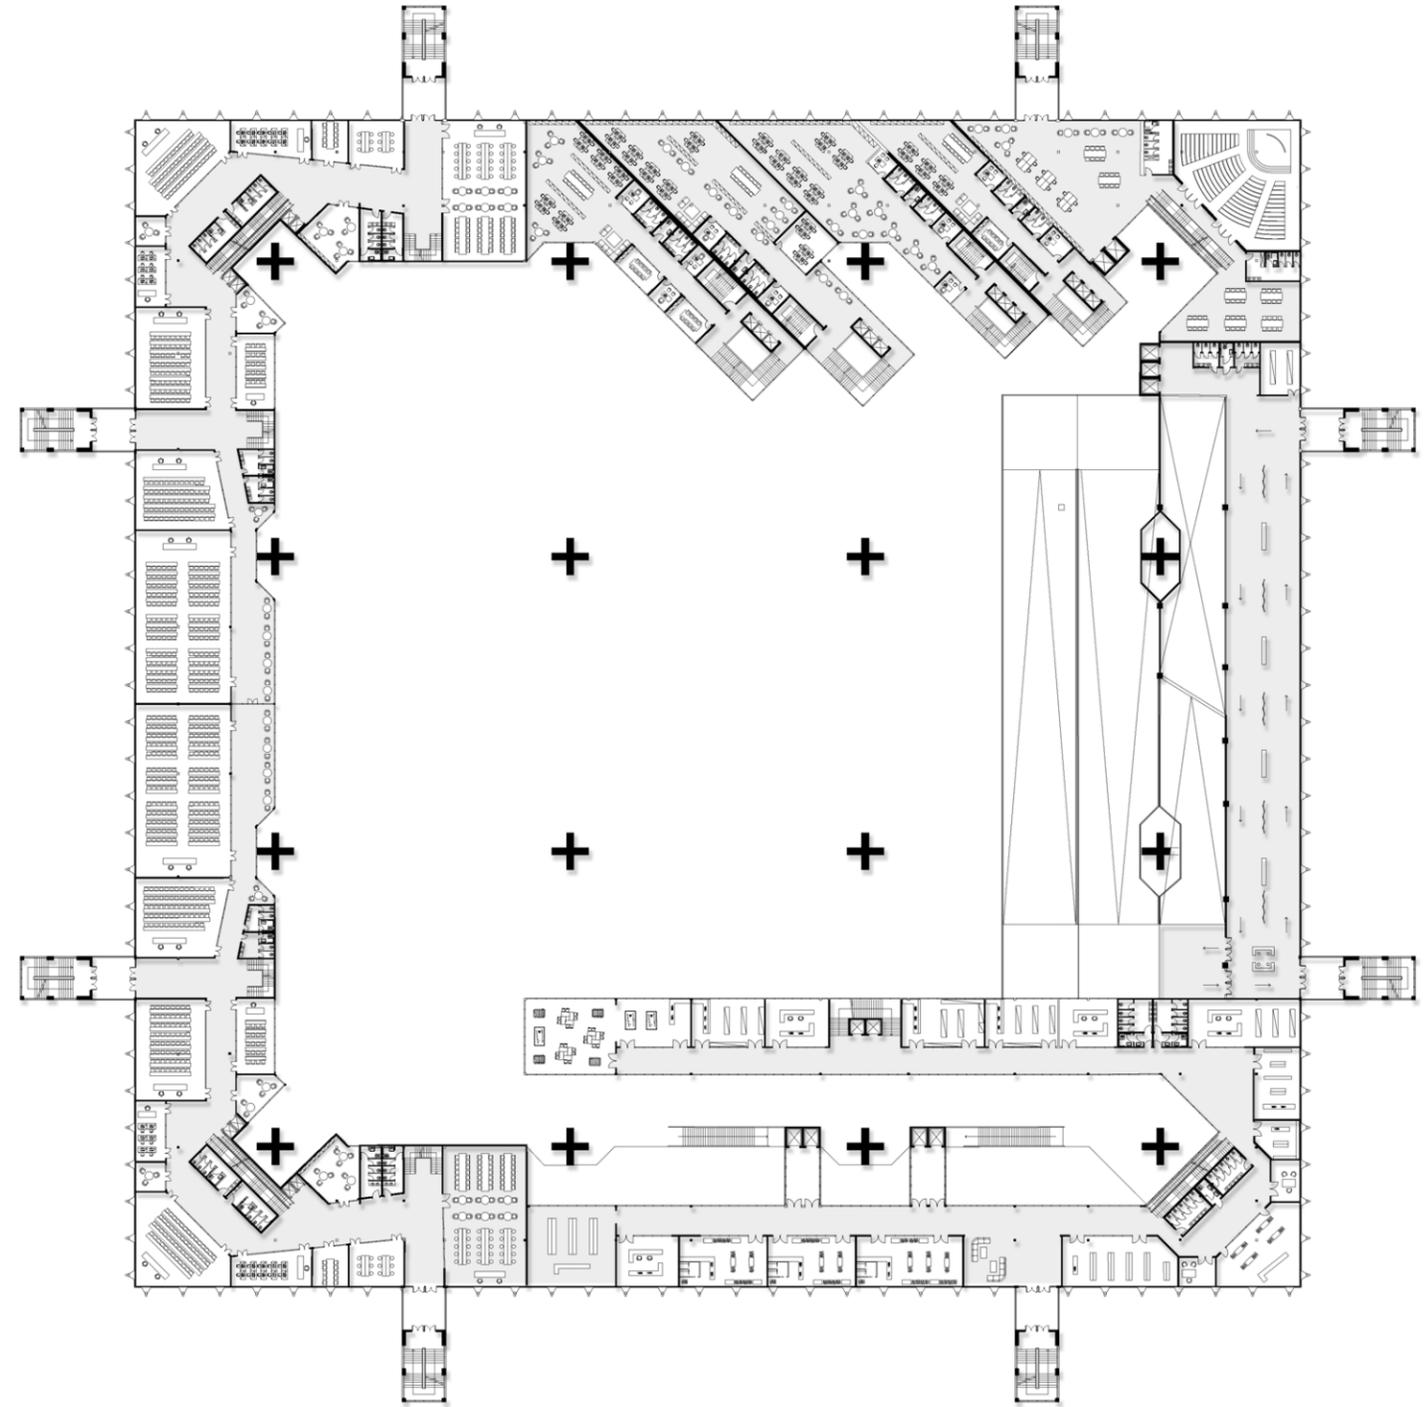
Pianta piano secondo dell'intervento Disomogeneità Omogenea, elaborato degli autori.
